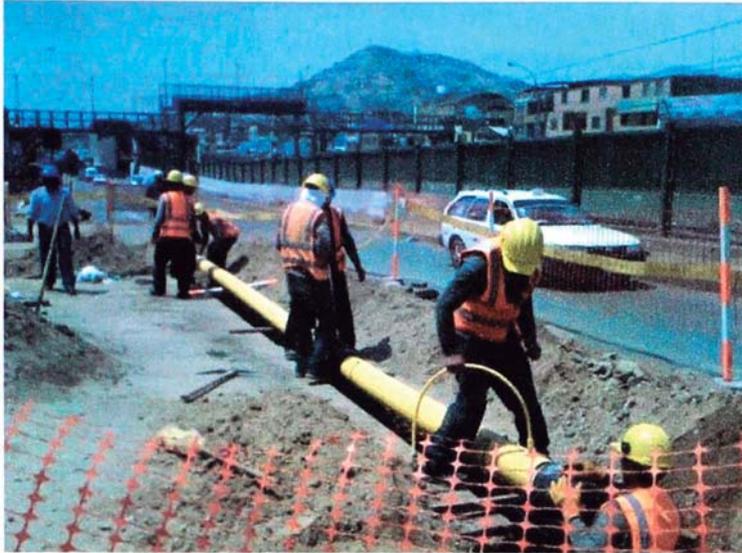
Instalación de tubería de polietileno previamente soldada fuera de zanja.
